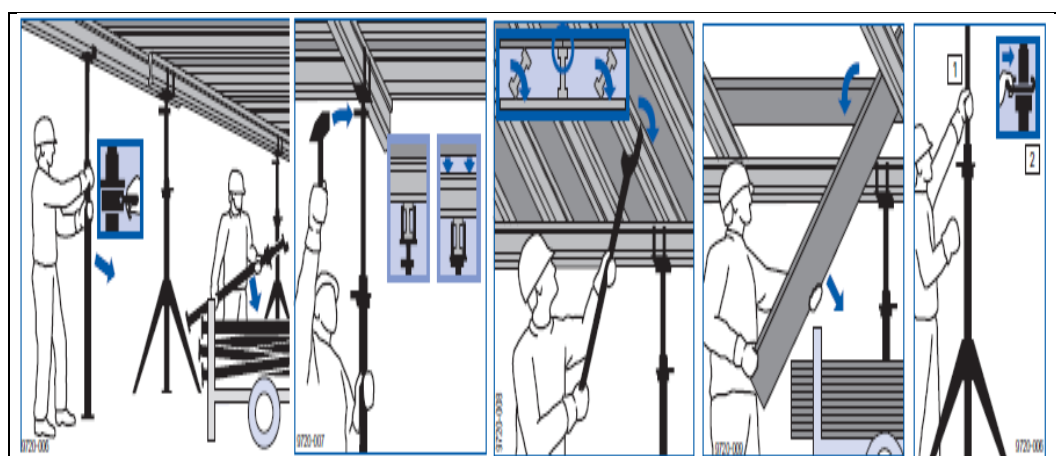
Desencofrado del sistema con desplazamiento horizontal.
